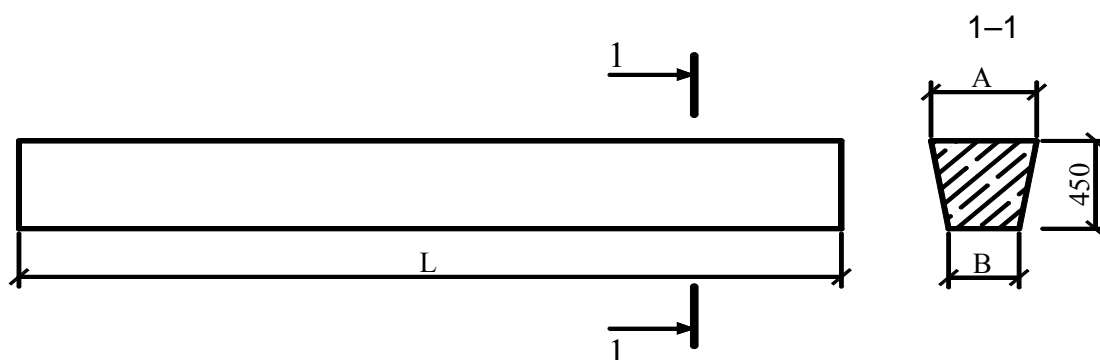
Фундаментные балки под стены из кирпича толщиной 250 мм и панелей самонесущих толщиной 200, 250 мм
